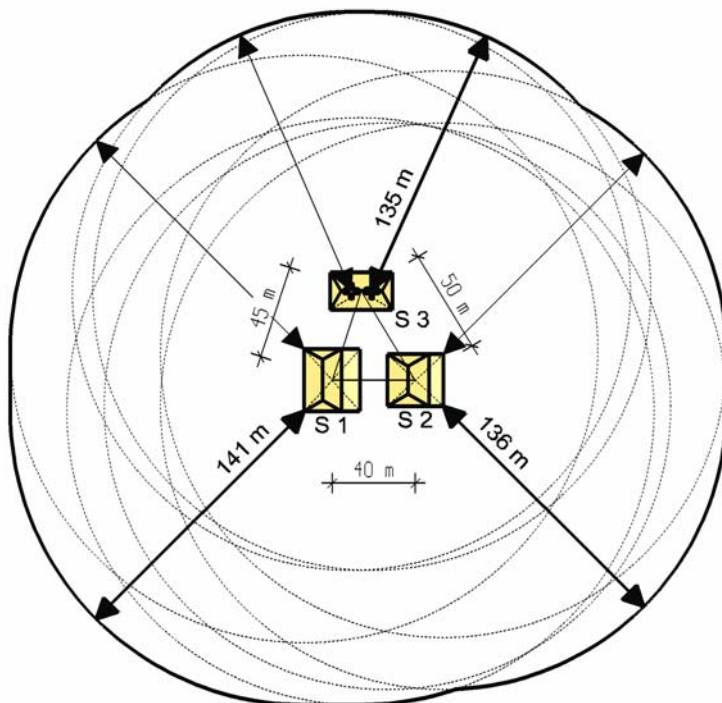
Distance minimale (=enveloppe) autour d'une installation comportant trois étales
